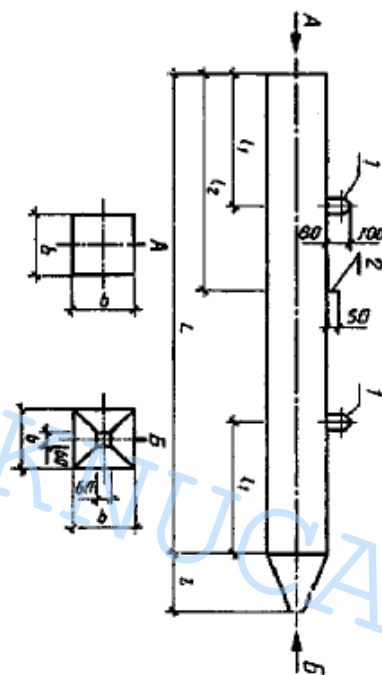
Палі типу ПН із суцільним квадратним перерізом, з поперечним армуванням стовбура з напруженою поздовжньою арматурою: 1 – підймальні петлі; 2 – штир для фіксації місця стропування під час підймання на копер. [9]
